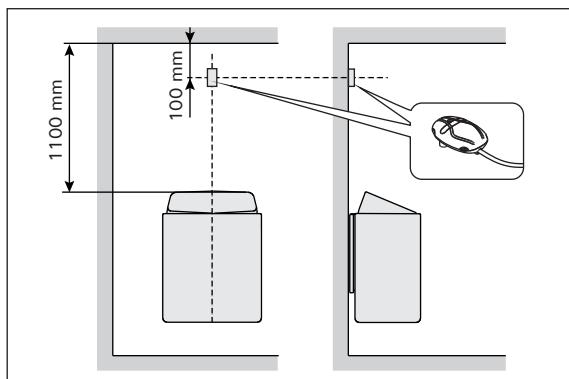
Lugar de la caja de sensores de los centros de control conectados con estufas montadas en la pared
